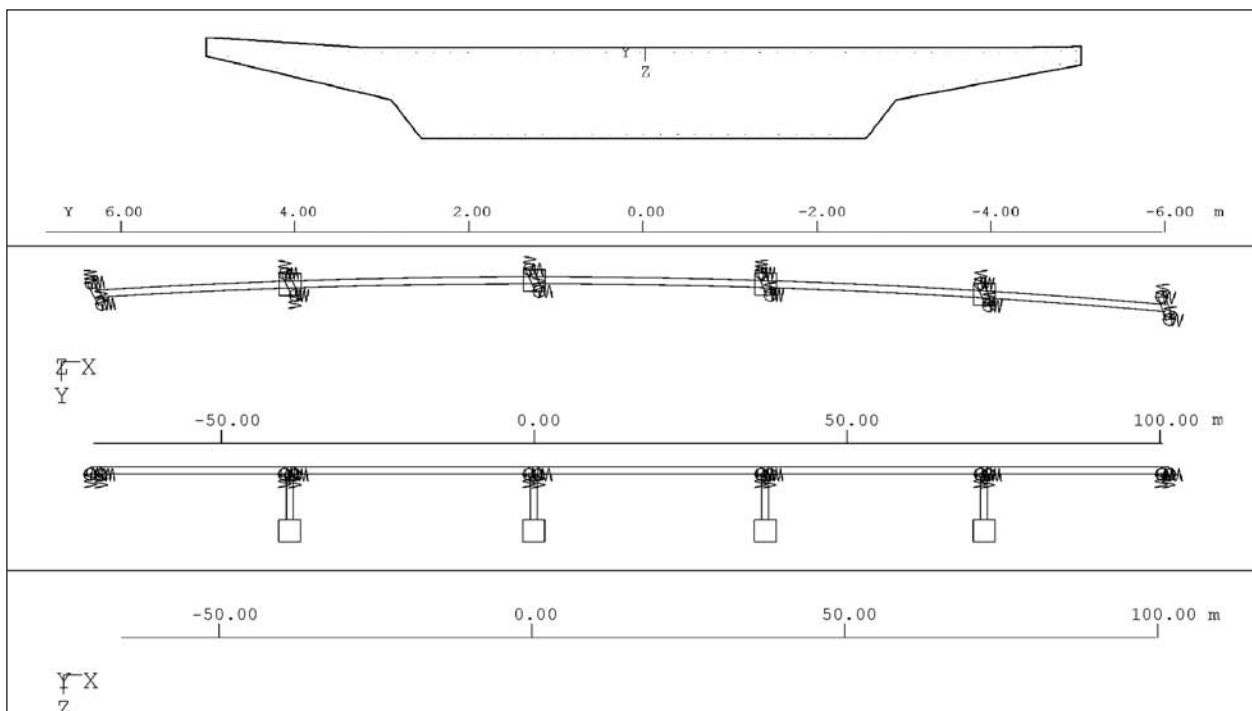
Querschnitt, Grundriss und Ansicht des Tragwerksmodells
